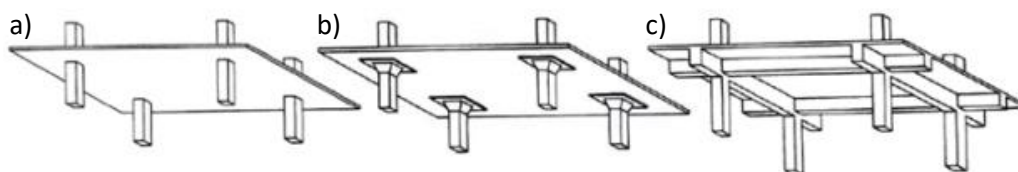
Principais tipos de laje: a) Laje fungiforme sem capitel, b) Laje fungiforme com capitel e c) Laje vigada, adaptado de [8].
